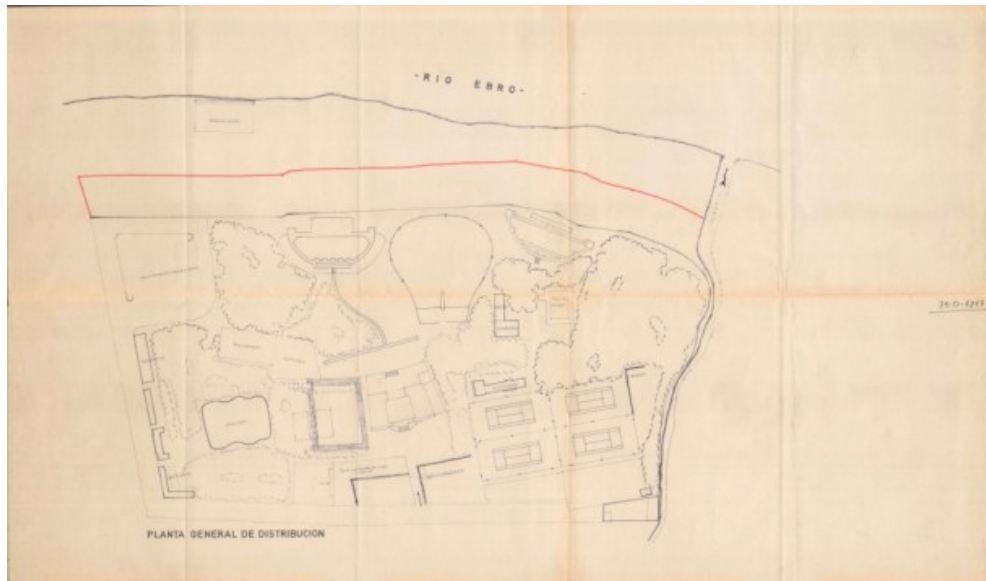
Plano aportado por S.D.T.P. en expediente de 1975
